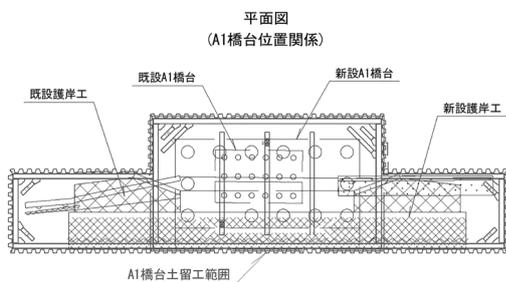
平面図(鋼矢板打設範囲及び構造位置関係)
